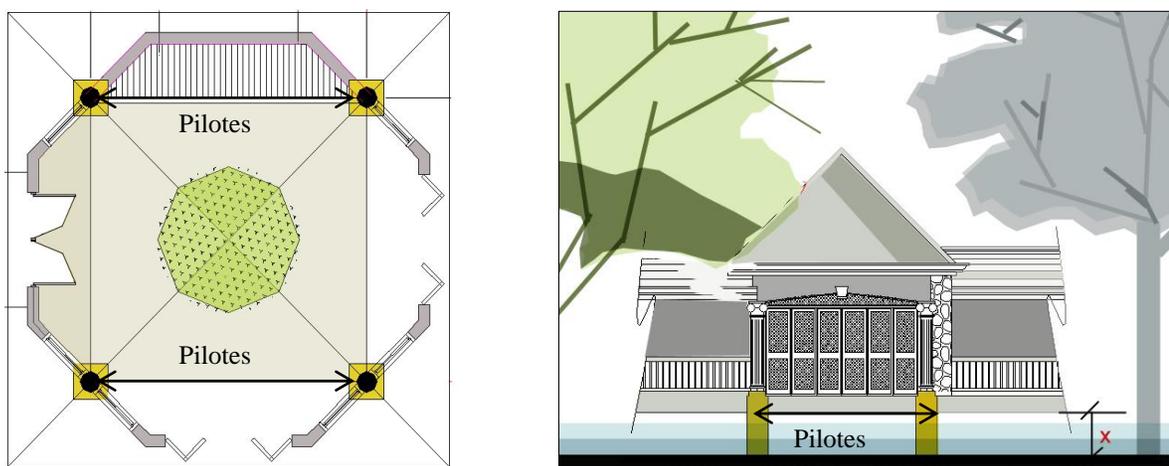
Ejemplo de planta (imagen a la izquierda) de casa de habitación que muestra la distribución de los pilotes y vista frontal (imagen a la derecha).
